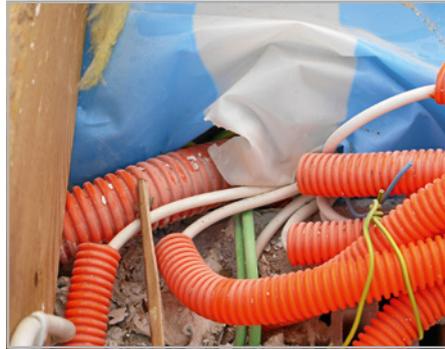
bis 222: Kabeldurchgänge können nicht abgedichtet werden.
